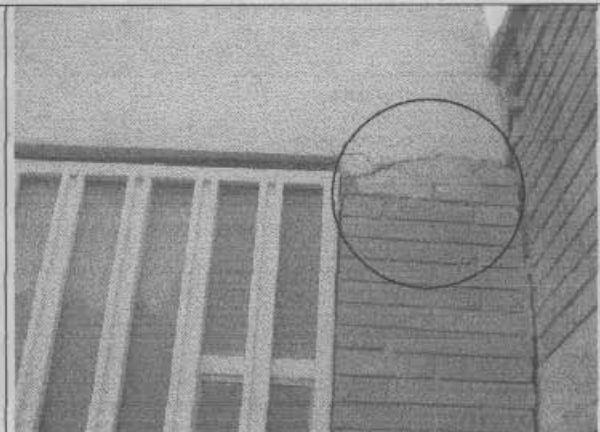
Muro del costado oriental en la fachada con fisuras
